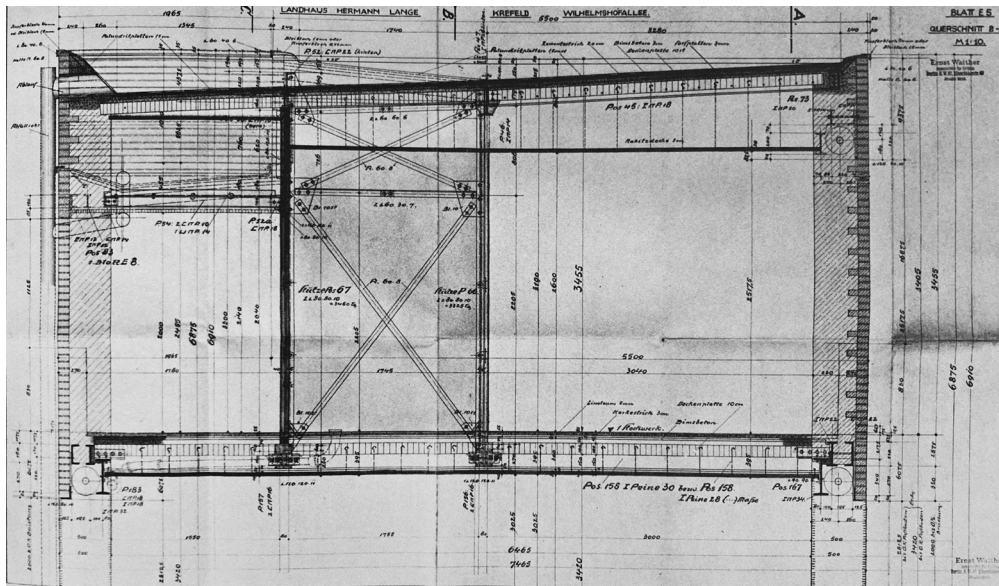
Mies van der Rohe. Entramado de perfiles estructurales al interior del muro de ladrillo de la Casa Lange, doc.6.180. *The Mies van der Rohe Archive* (1992)
